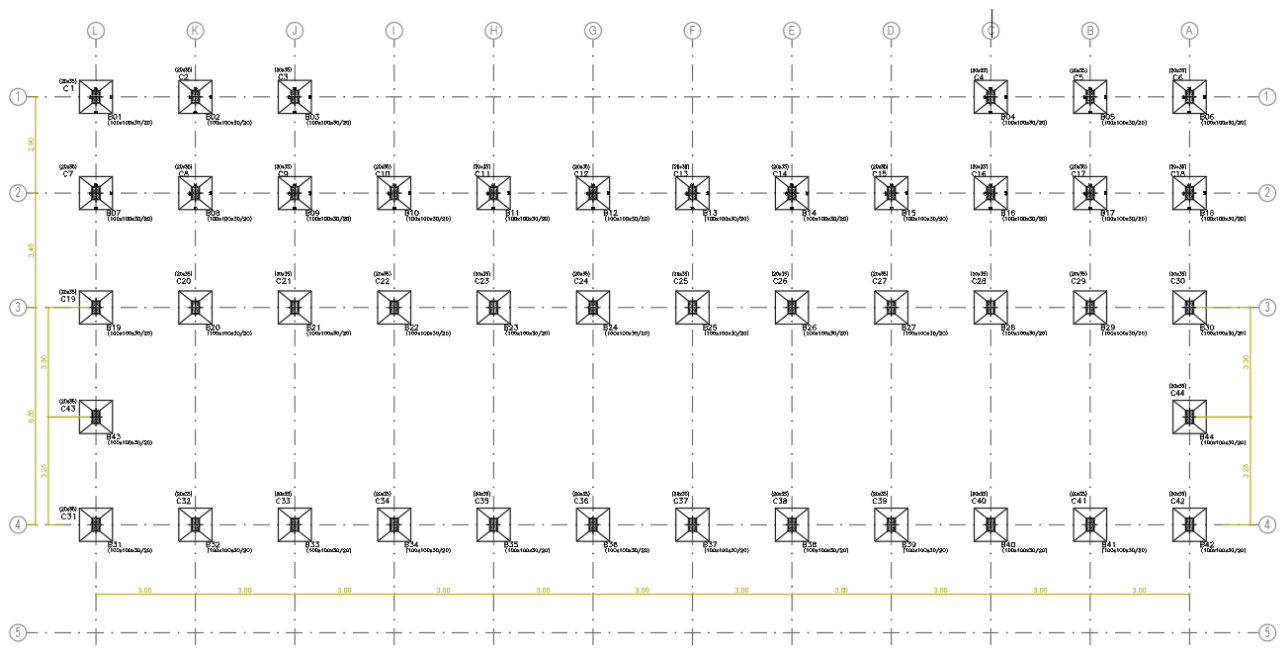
ESTRUCTURA DE HORMIGÓN | FUNDACIÓN
